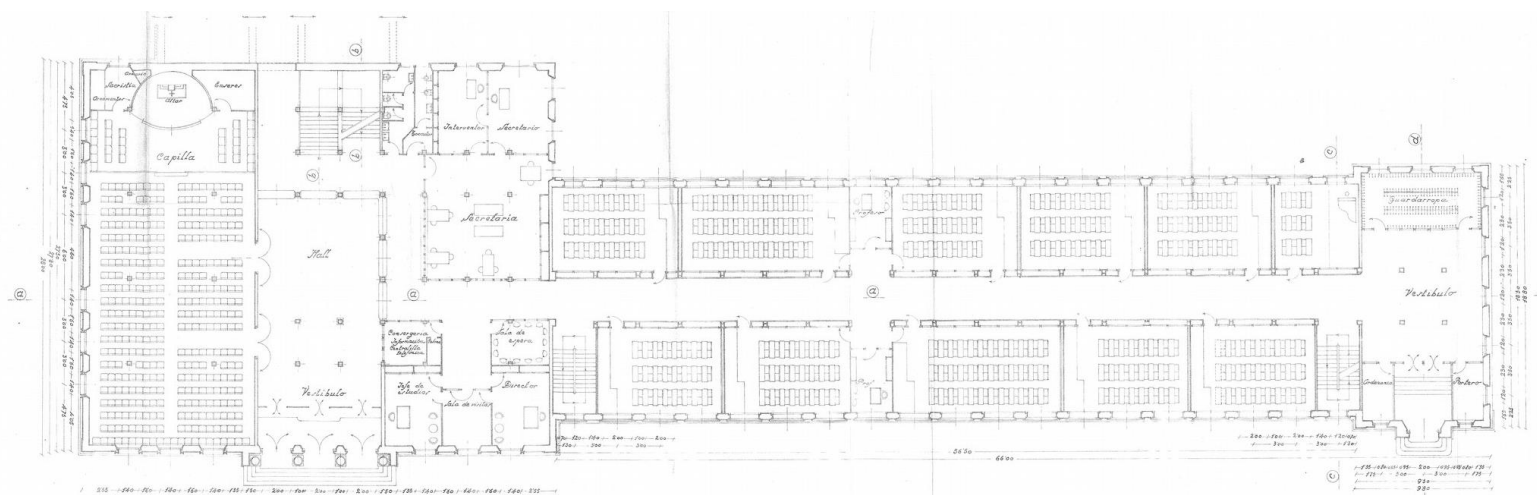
Plano de la planta principal, Manuel Sureda 1942
